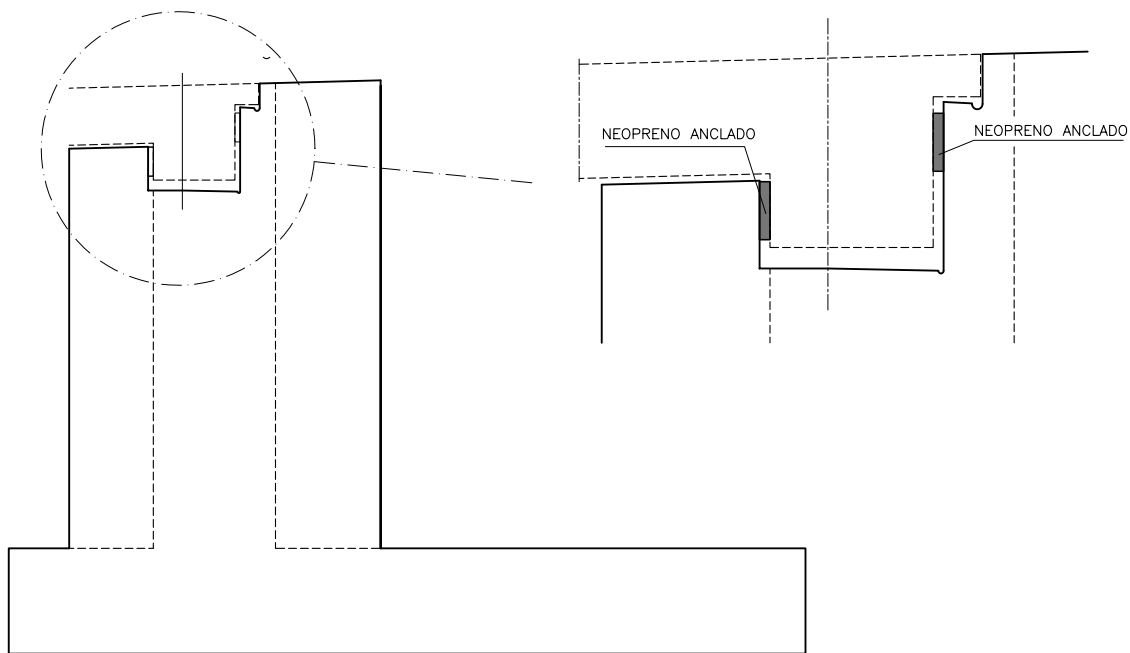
Estribo fijo de tablero tipo losa pretensada. Sección y detalle de anclaje
